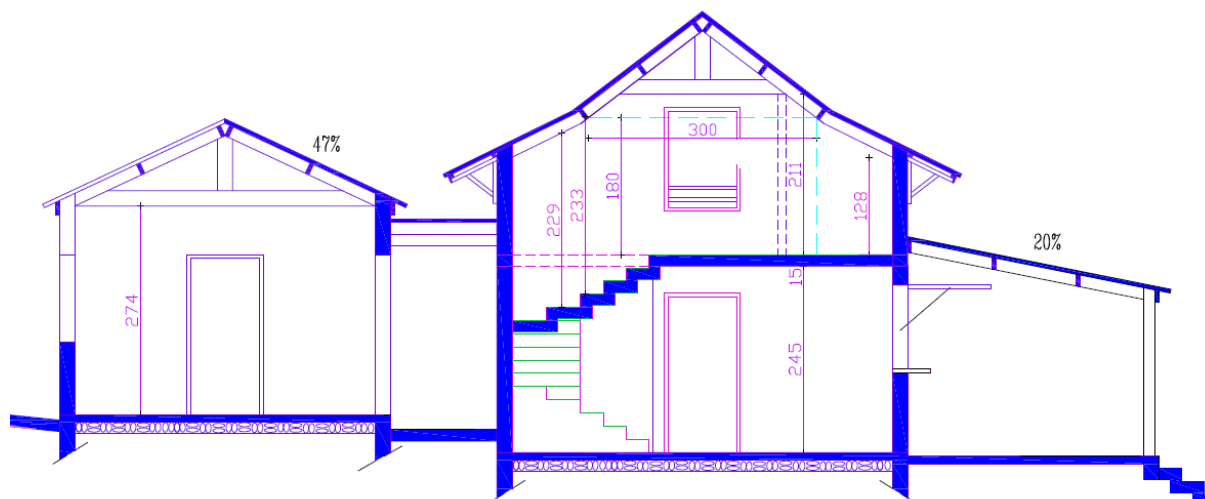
Coupe Maison PERENE Z3 Ouest, isolation avec plafond rampant, protection solaire par large débord de toiture
